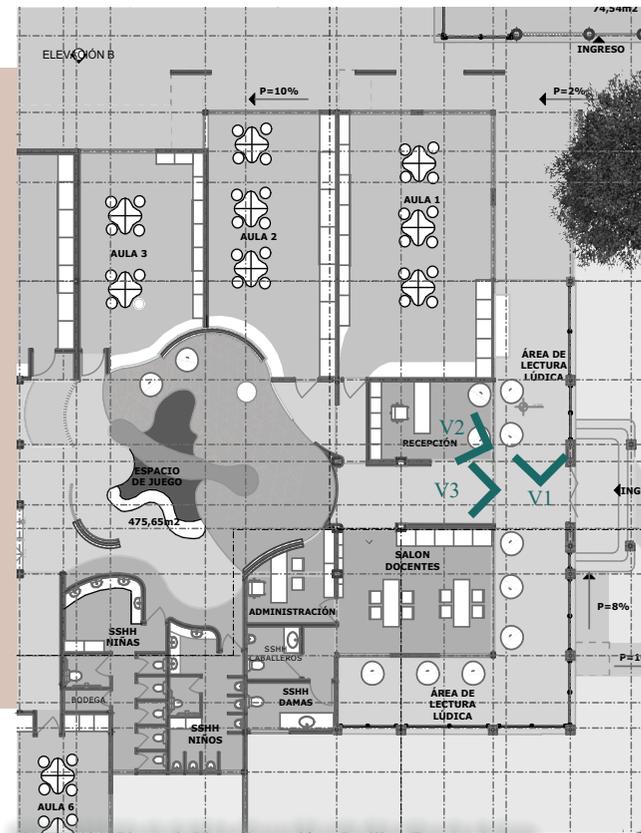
Planta de Vistas Recepción y Pasillos. Fuente: Autora.
